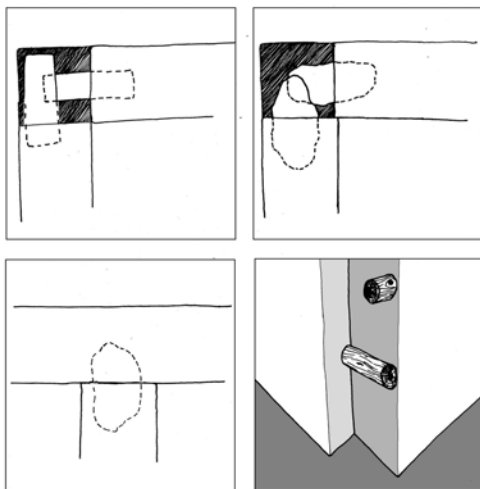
Esquemas de ligação entre paredes por pedras ou troncos de madeira
